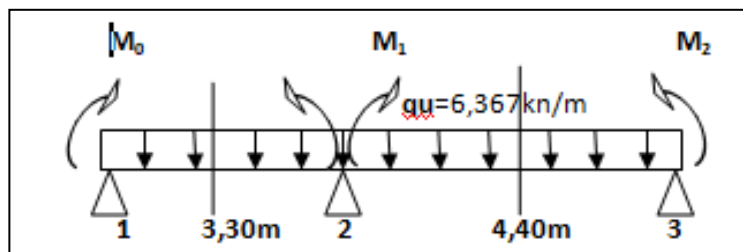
schéma statique de la poutrelle type 1 à l'ELU
